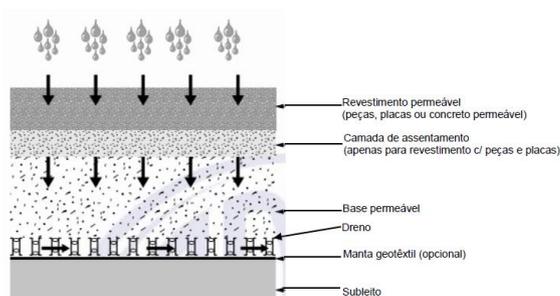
Exemplo de sistema de pavimento permeável sem infiltração. Fonte: NBR 16416 (2015).
